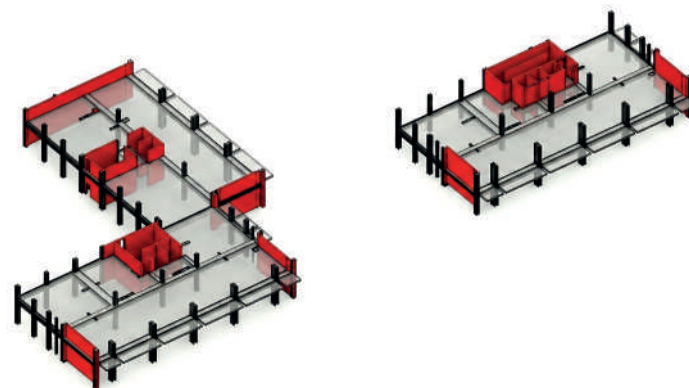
Planta (Vista 3D). Floor plan (3D view).
